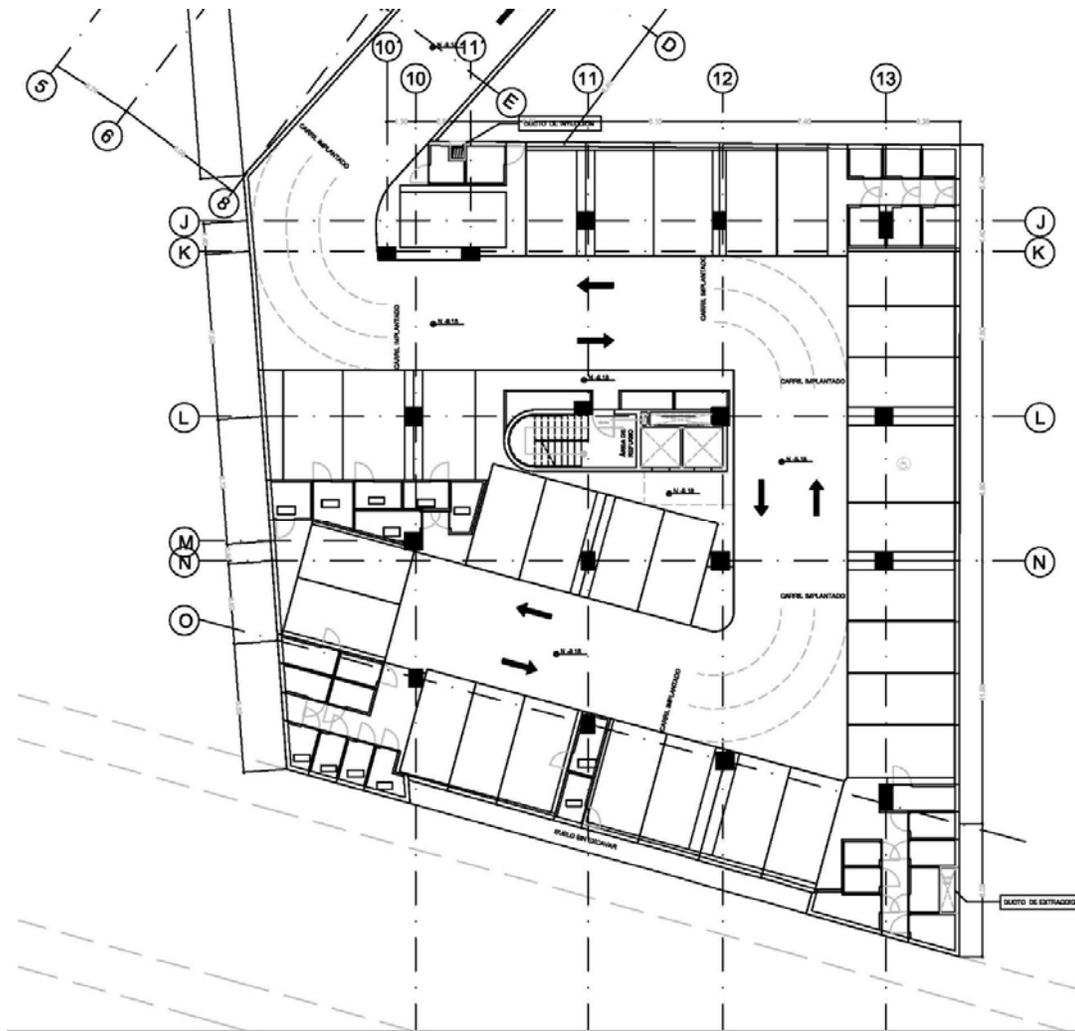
Planta Estacionamientos Tipo-Whimper. Elaborado por: ARQUITECTURA X
